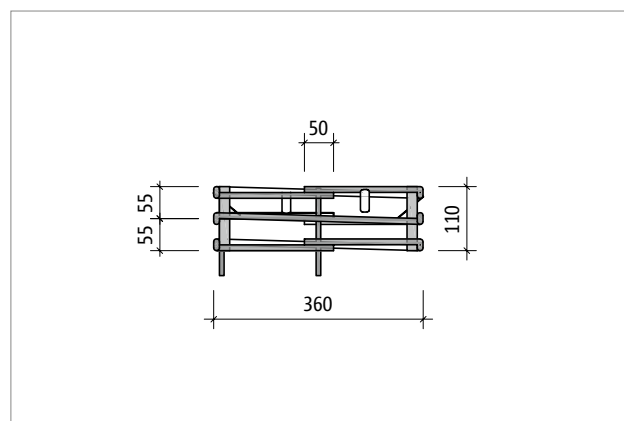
Schöck Sconnex® Typ P-B400: Seitenansicht Part T; geschweisste Bügel und Biegeformsegmente aus Edelstahl
